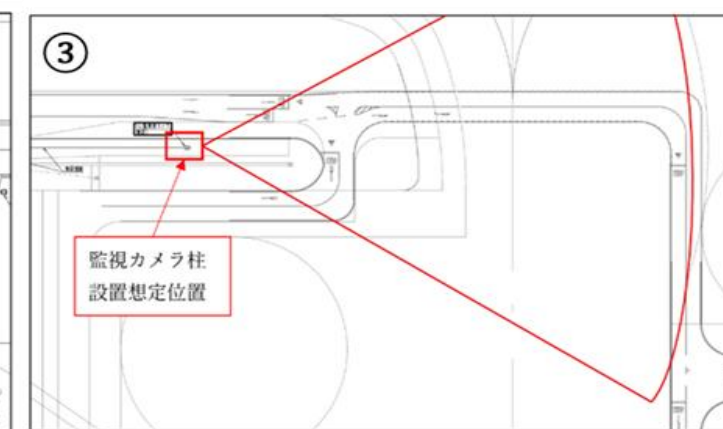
国際線 GSE 橋梁南側サービスレーン合流地点 平面図
